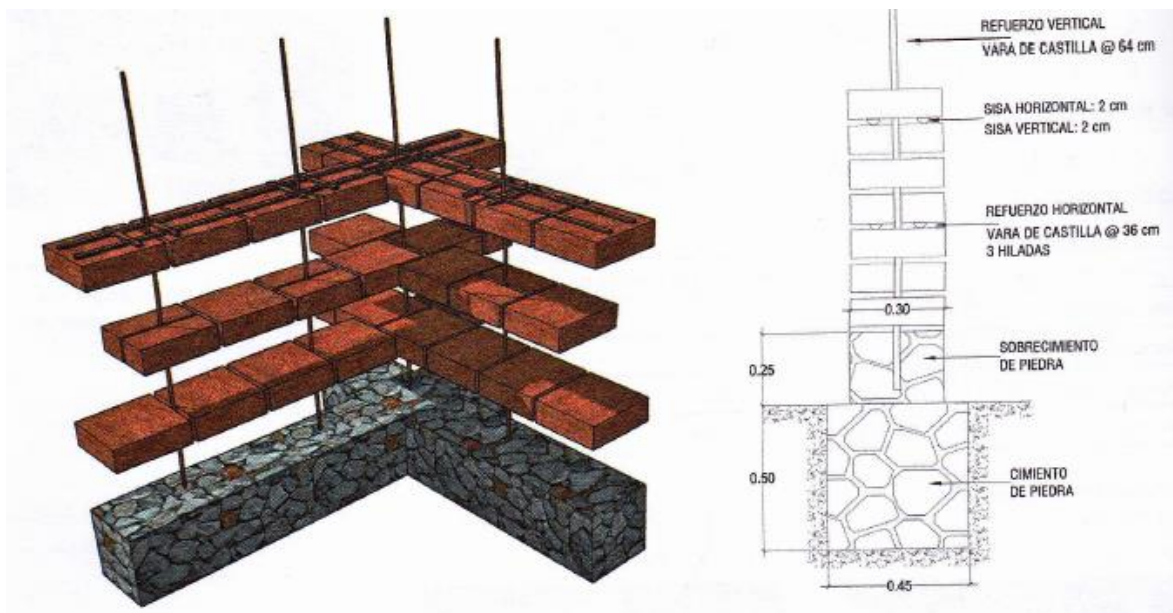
, Detalle de sección de pared con cimiento y sobrecimiento
